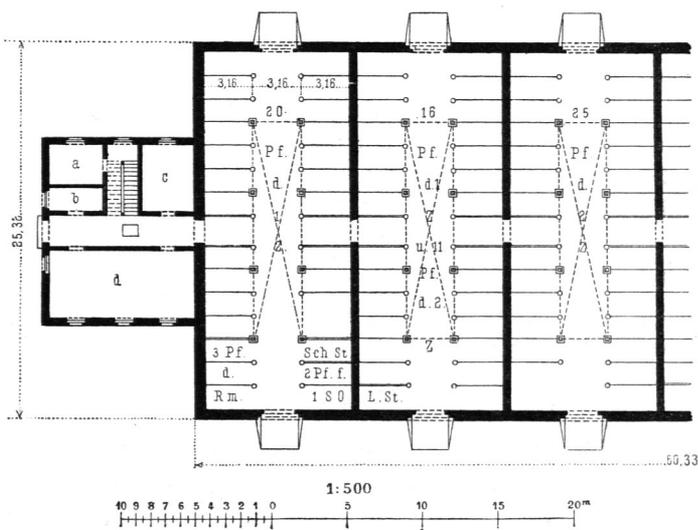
stellt den halben Grundriß eines österreichischen Escadron-Stallgebäudes mit Querreihenstellung⁴⁹⁶⁾ dar. Die Erleuchtung wird hauptsächlich durch große Deckenlichter in den Dachflächen bewirkt.
